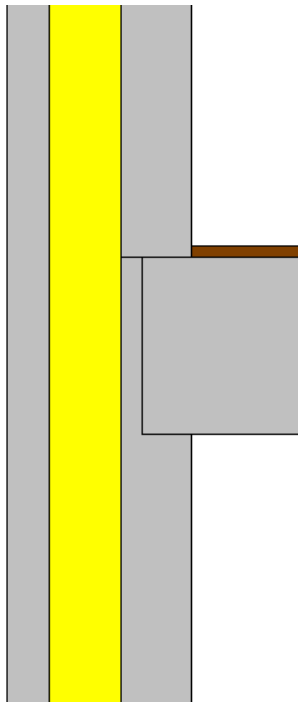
Snitt av sandwichelementvegg (Sintef, 523.611 Betongelementer i fasader, 1994)
